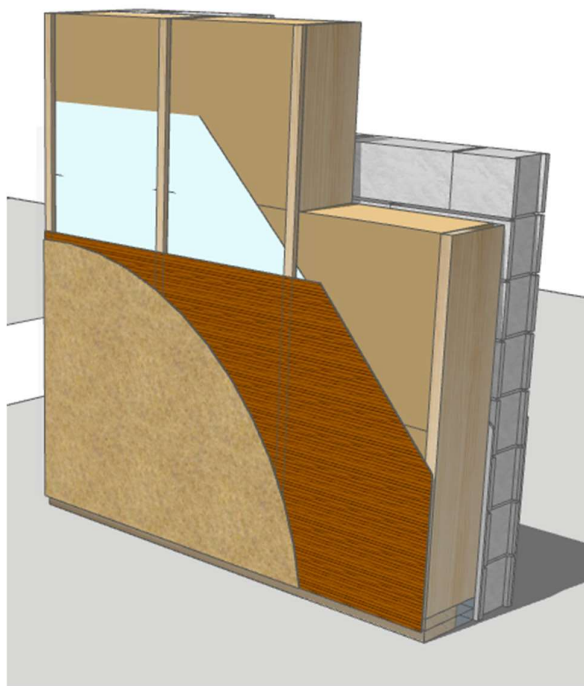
Schéma de principe d'un enduit terre sur support canisse sur mur en parpaing existant- AMACO
